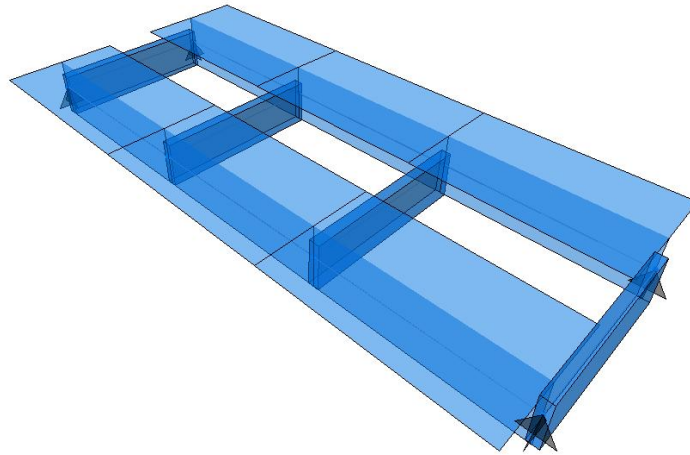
Modelo estrutural para a ponte considerada em viga biapoiada
